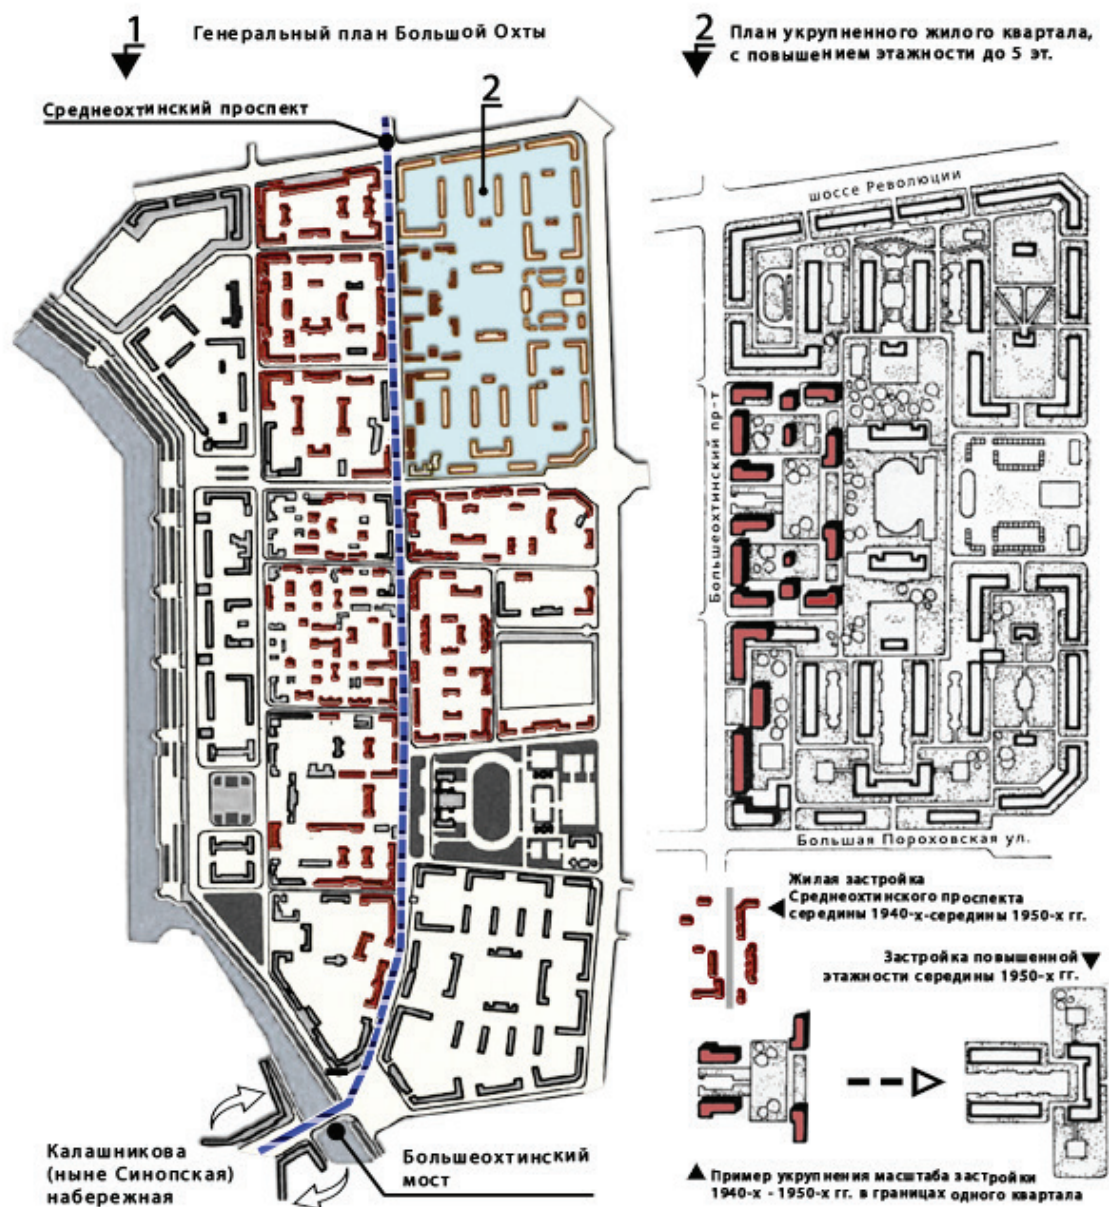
Генеральный план Большой Охты. План укрупненного жилого квартала в северной части Большой Охты [4, с. 108,111]
